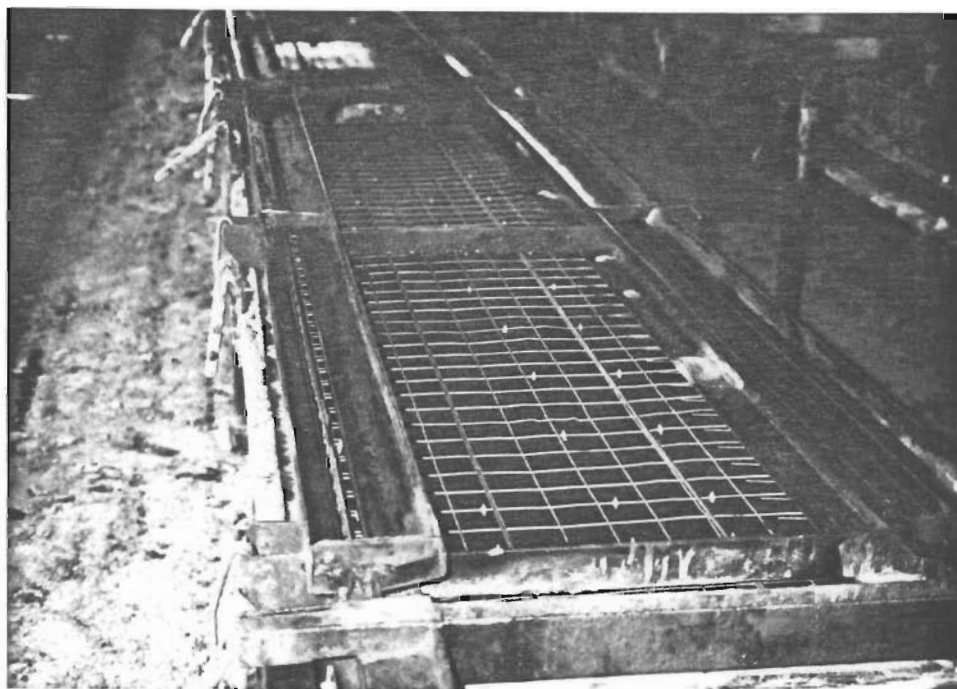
Detalhe de fôrma metálica fixa utilizada na produção de telhas e painéis divisórios no Cedec/Emurb.
